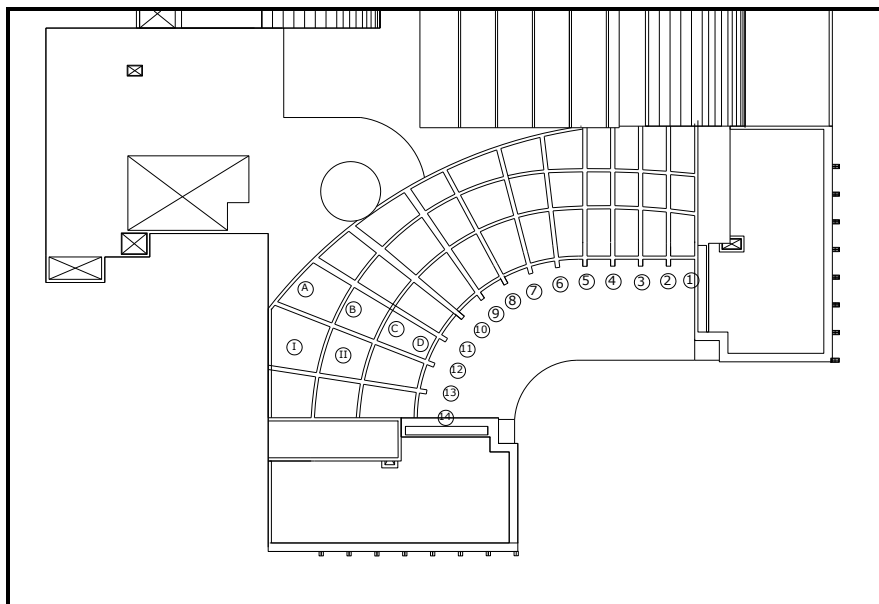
Distribución y numeración de vigas en losa de azotea del hotel Alameda. (E. Paredes, 2010).
